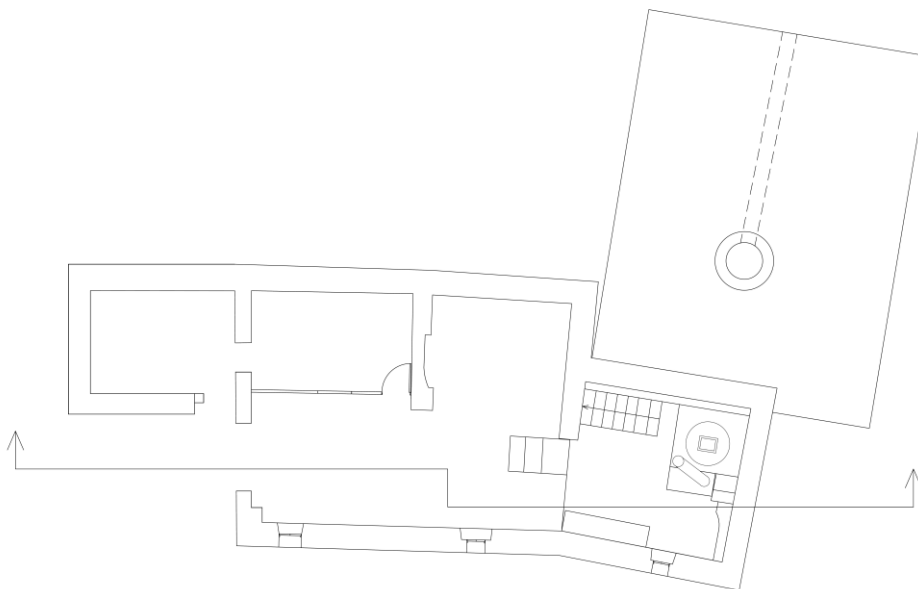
Planta Baixa de l'edifici original del molí. (Font: Autor.)
